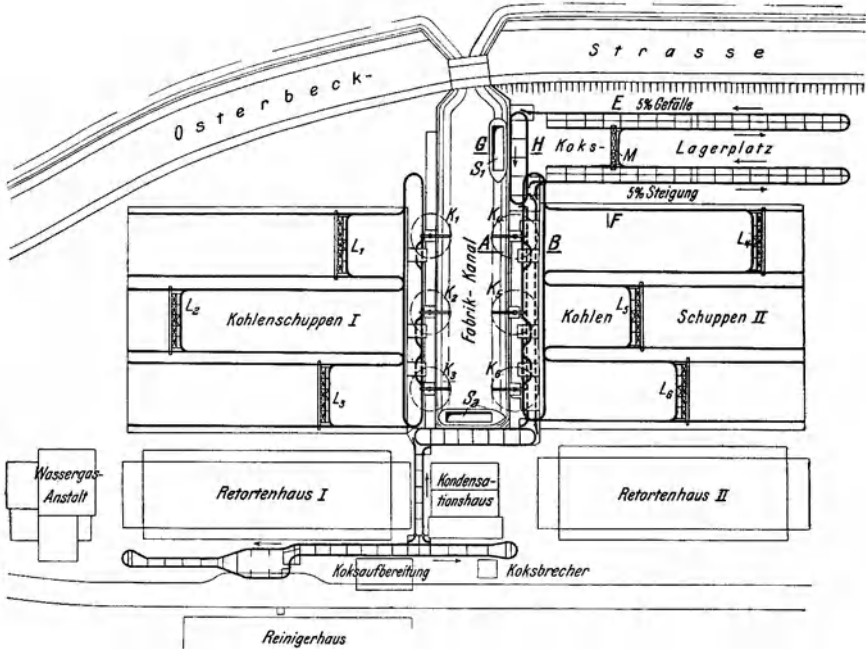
Lageplan der Elektrohängebahnen im Gaswerk Hamburg-Billwärder (Bleichert).
